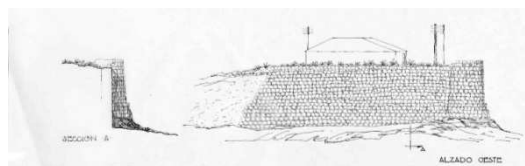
Muralla medieval de Hita. Alzado oeste y sección A-A'. Fuente: www.hita.es
